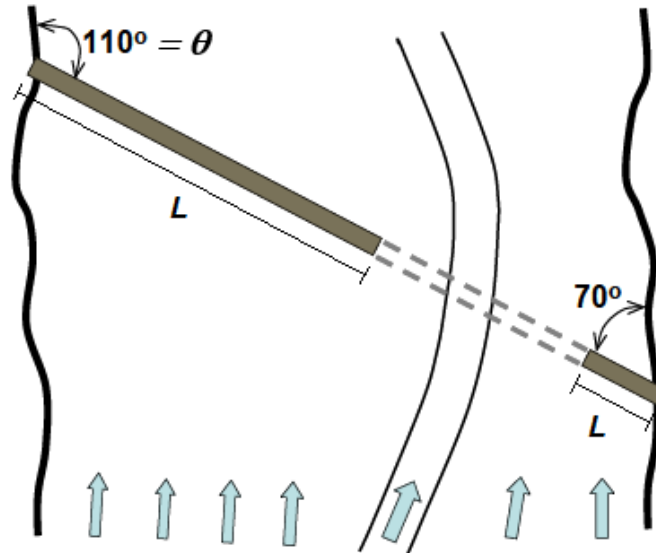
Calcolo dello scalzamento in corrispondenza delle spalle.
